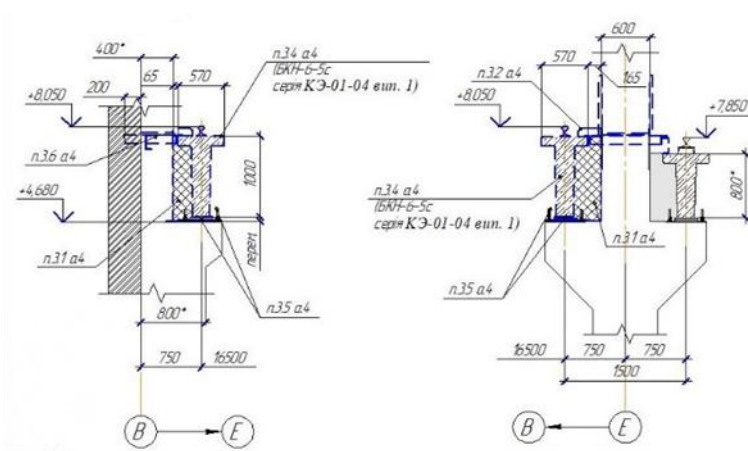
Схеми демонтажу залізобетонної підкранової балки
